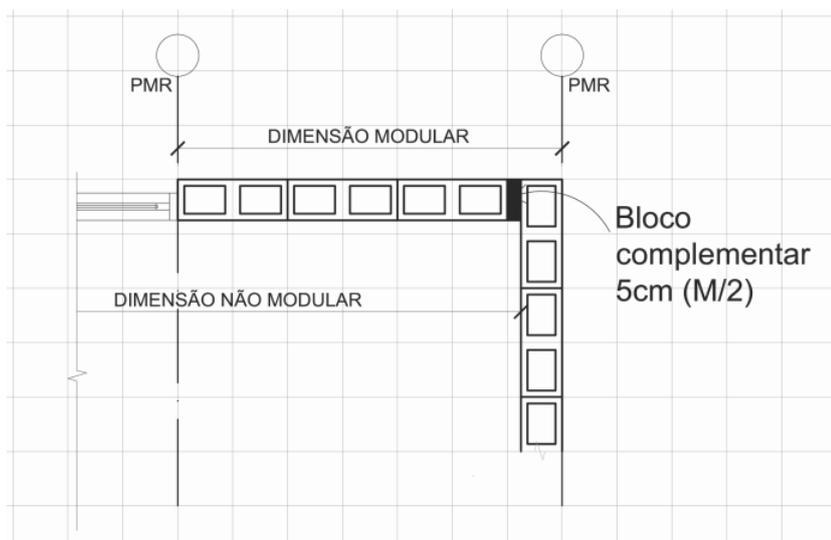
Incremento de bloco complementar em planta baixa. Fonte: AMORIM et al, 2010, a.
